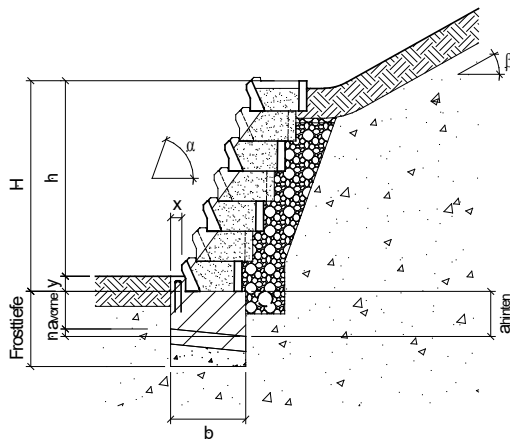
VERDURO® Böschungselemente, Lastfall D und E Hinterfüllung mit Böschungsneigung oberhalb der Mauer
